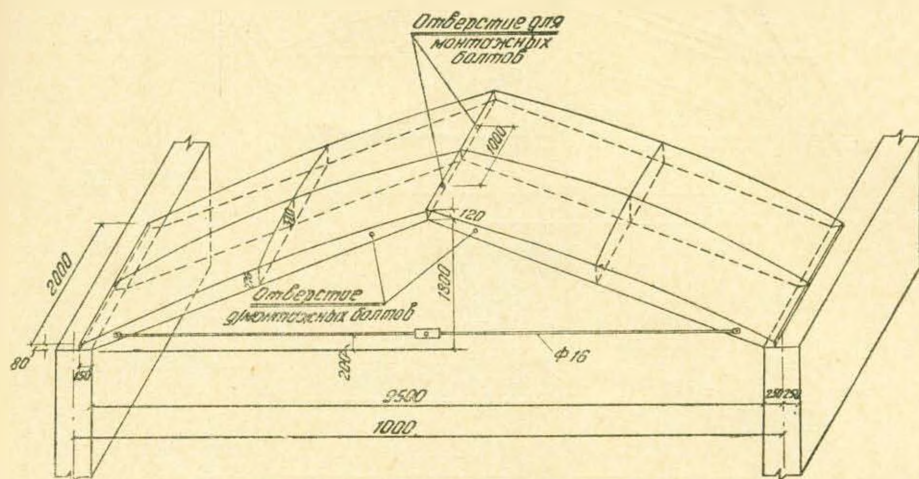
Сборное железобетонное покрытие в виде оболочки с затяжкой.
